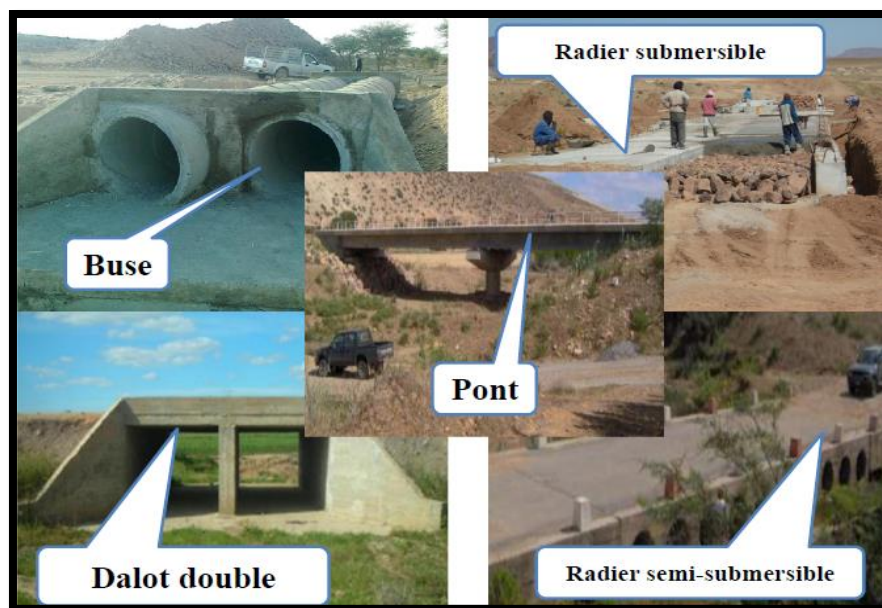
Exemple d'un ouvrage de franchissement.
